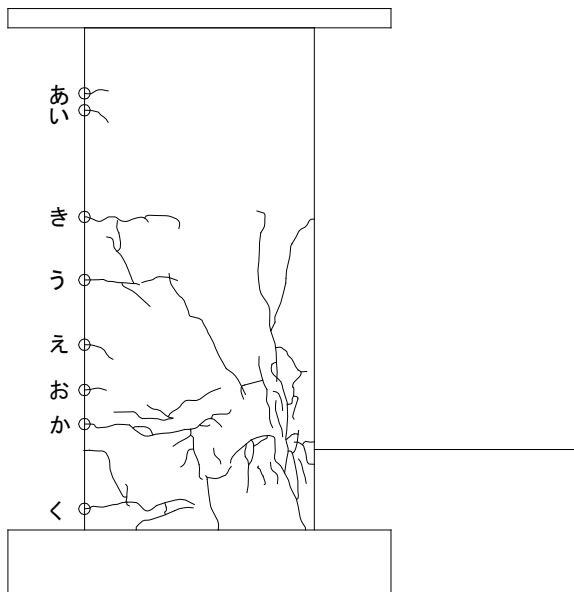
基礎梁ひび割れ幅測定位置(試験体 A-6 正載荷)
